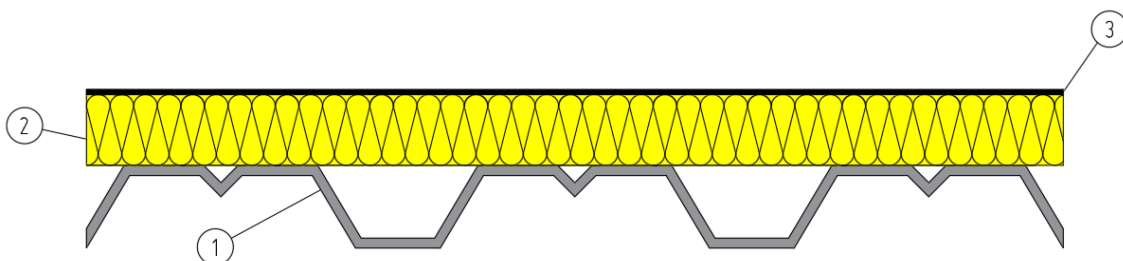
Detalle Constructivo Cubierta del Local. Elaboración propia
